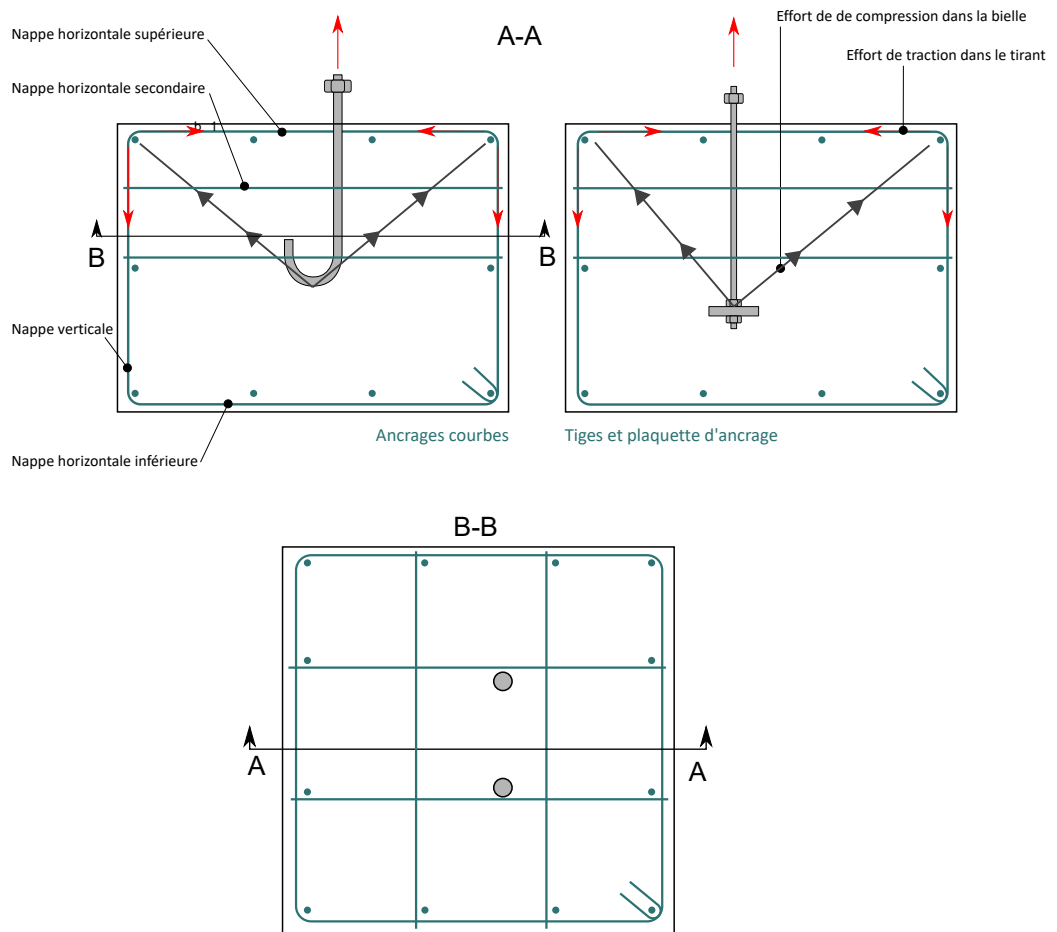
Exemple de ferrailage d'un groupe de deux ancrages, positionnés dans un massif béton
